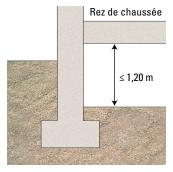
Vide sanitaire non considéré comme un niveau : condition sur la hauteur
